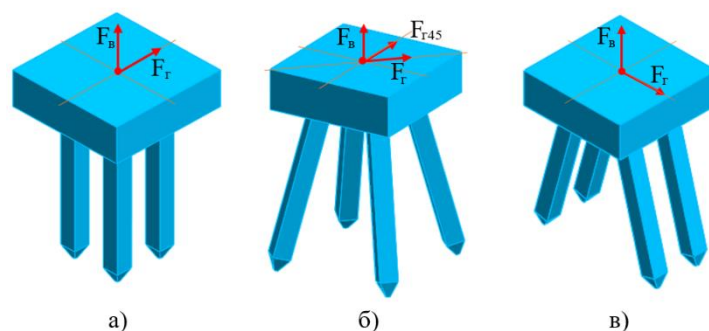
Свайные фундаменты: а – стандартный с вертикальными сваями, б - крестообразный, в – попарно-параллельный
